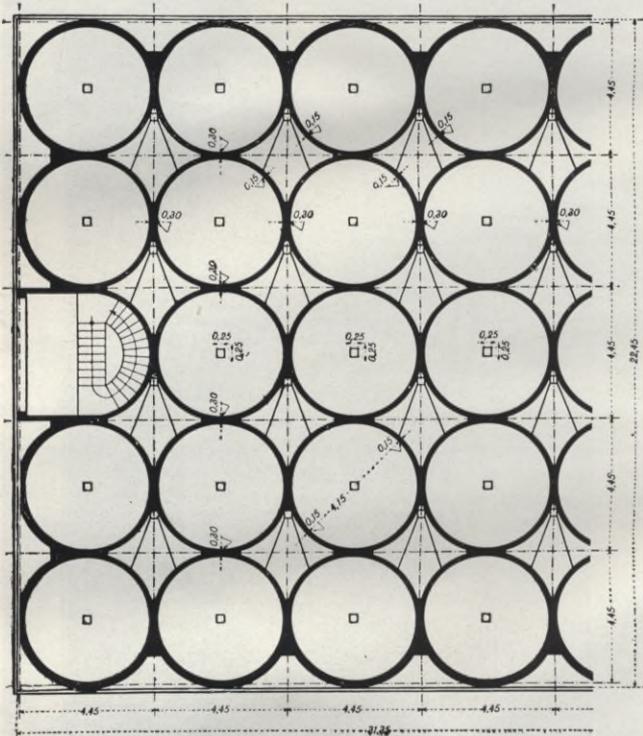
Grundriß zum Getreidesilo in Castellammare.
